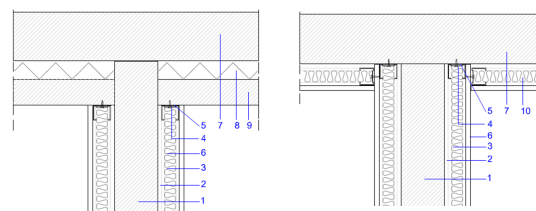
y 6 – Encuentros Tabique mixto con fachada en planta
